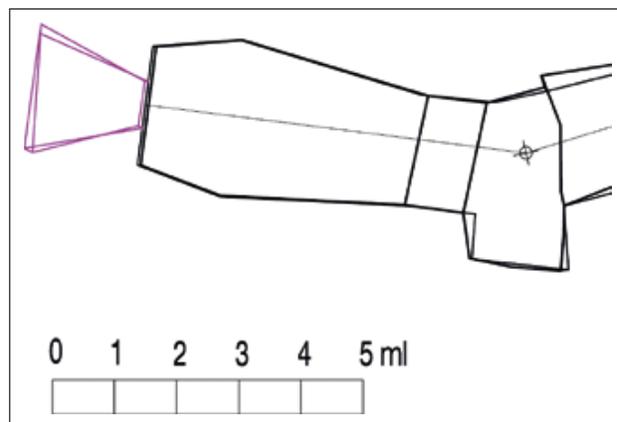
Planimetria tipica di una piazzola di artiglieria (disegno C. Dal Bianco).
